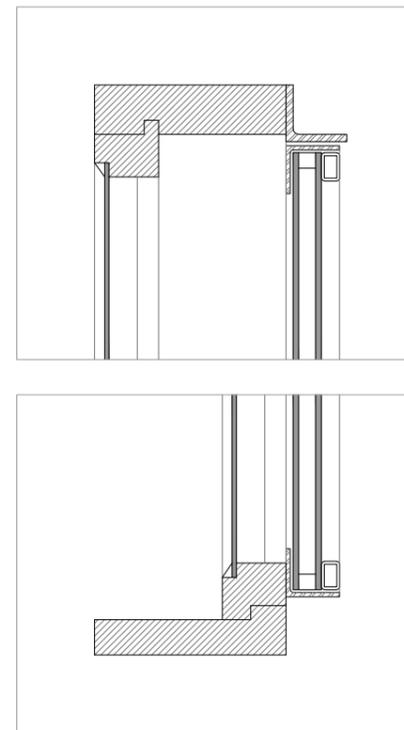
Perfil de Nova Caixilharia da Parede-cortina | Escala 1:5
